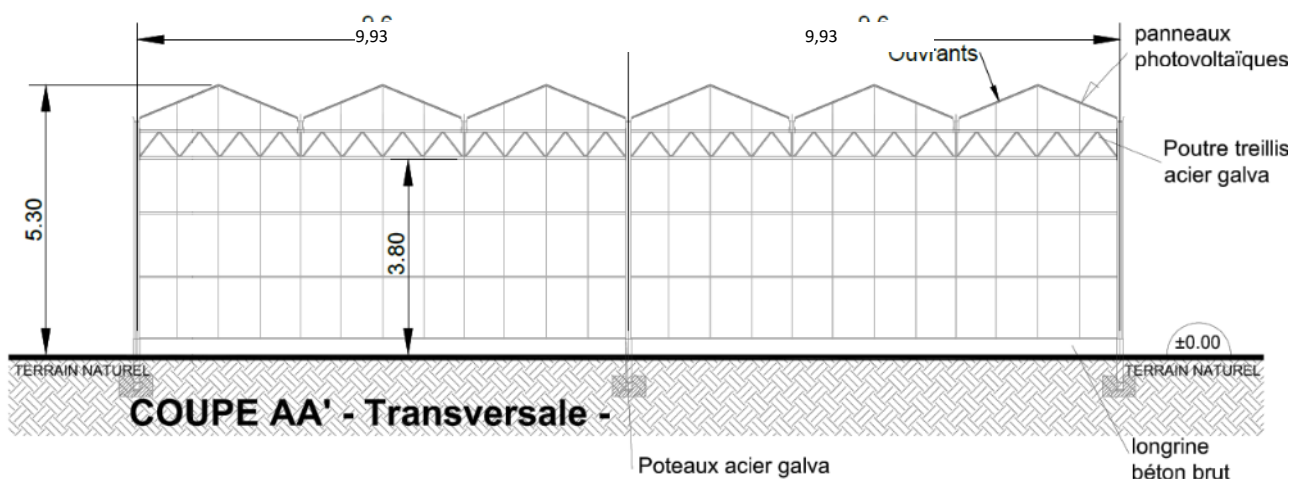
Coupe type serre multi-chapelles, côté pignon. Reden.
